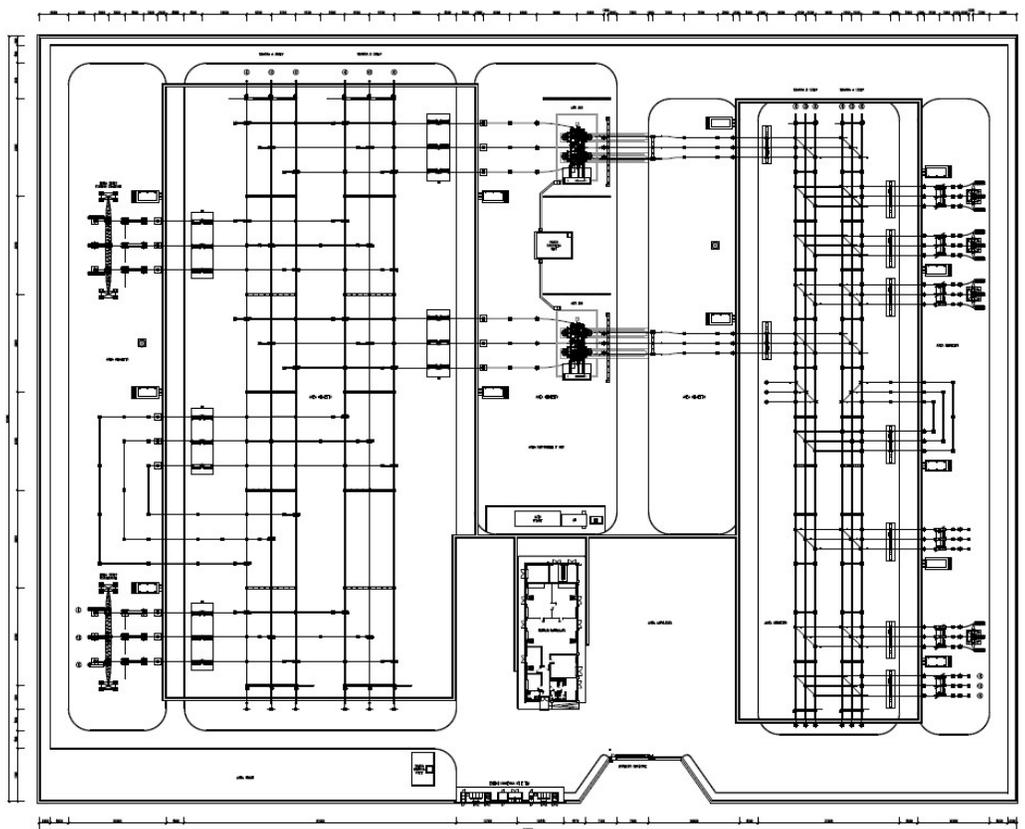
PLANIMETRIA DELLA STAZIONE SE 380/132 kV RTN CARISIO
